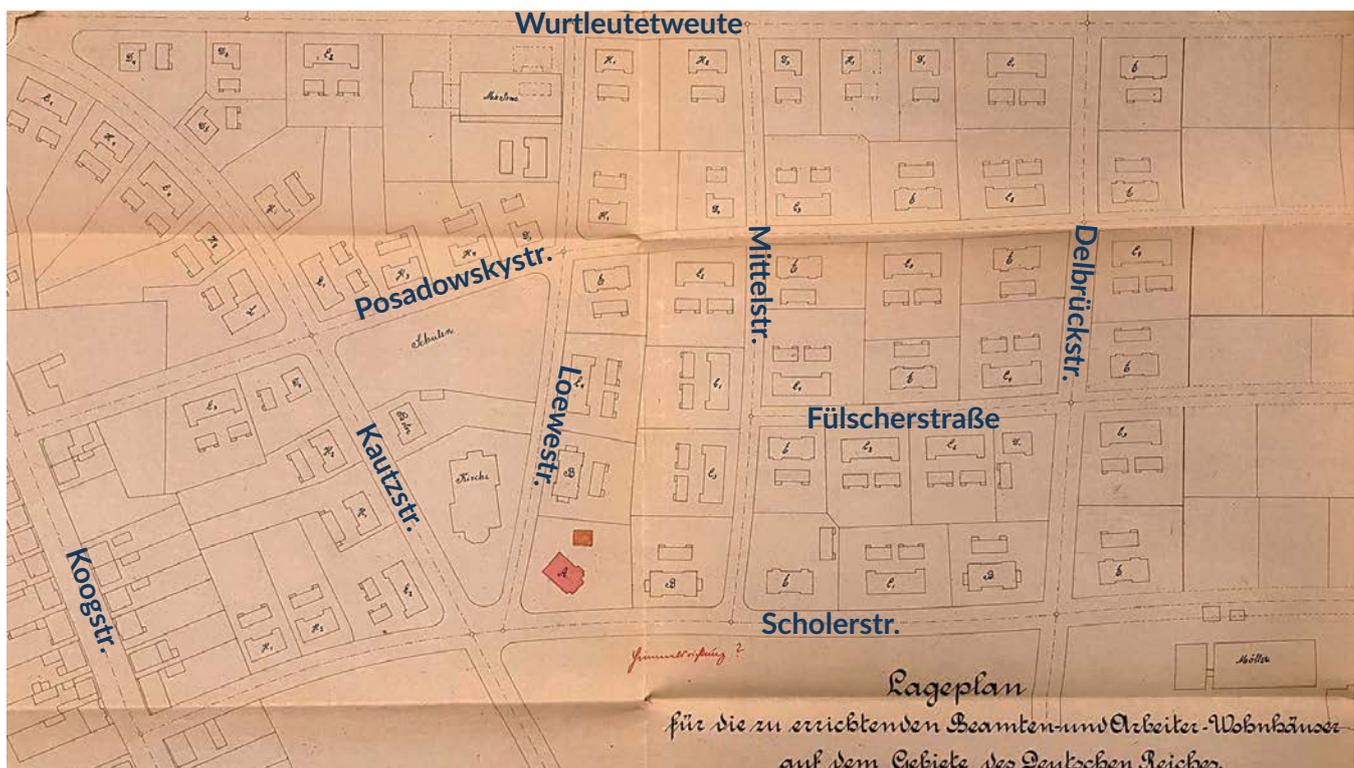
Lageplan des Beamtenviertels aus dem Jahre 1908 mit Angabe der Haustypen (nicht genordet, bearbeitet A+S)
